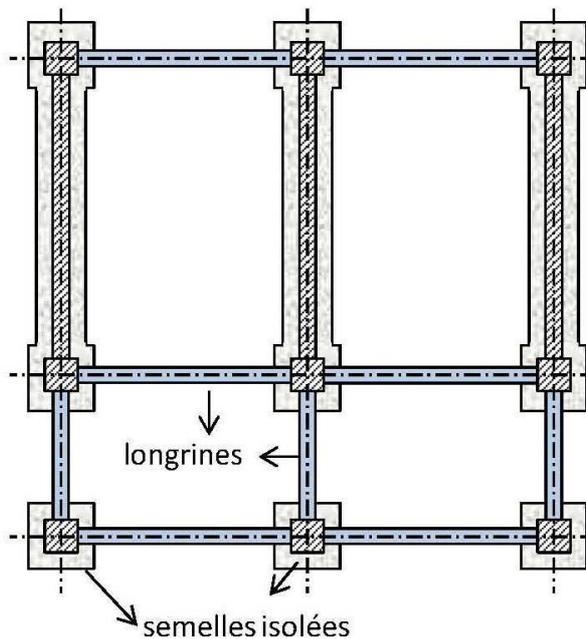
Exemple de liaisonnement des fondations isolées
